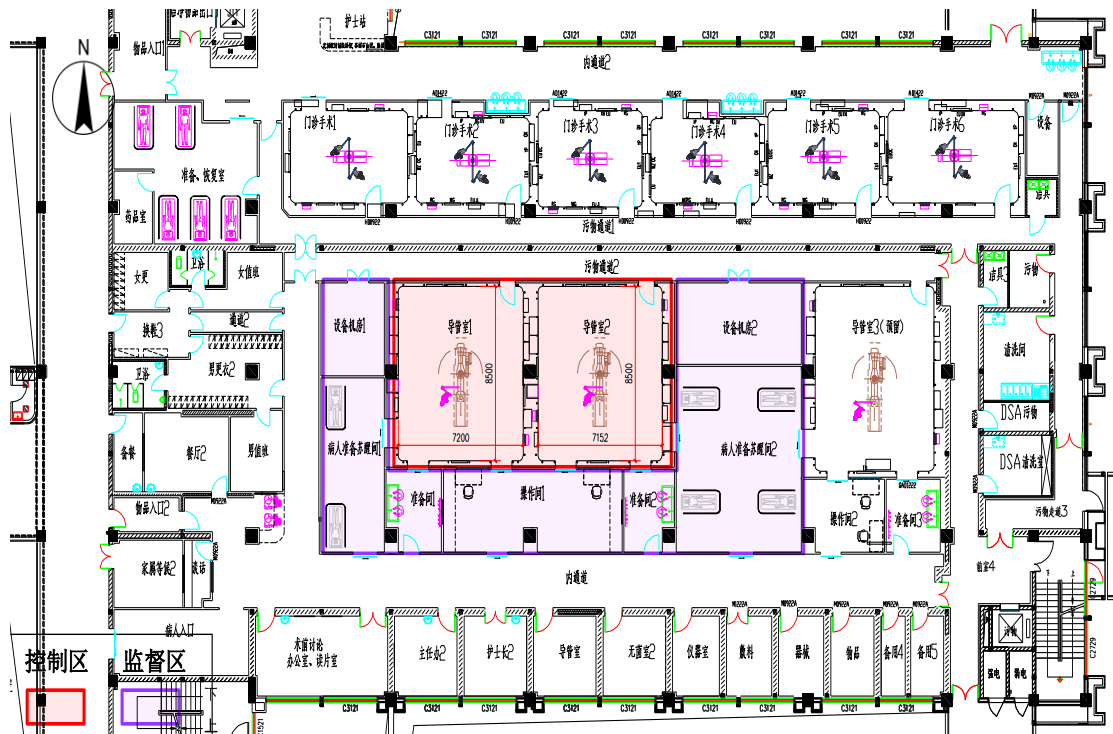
敌山湾院区 2 号楼三层 DSA 机房平面布置及周围环境示意图
